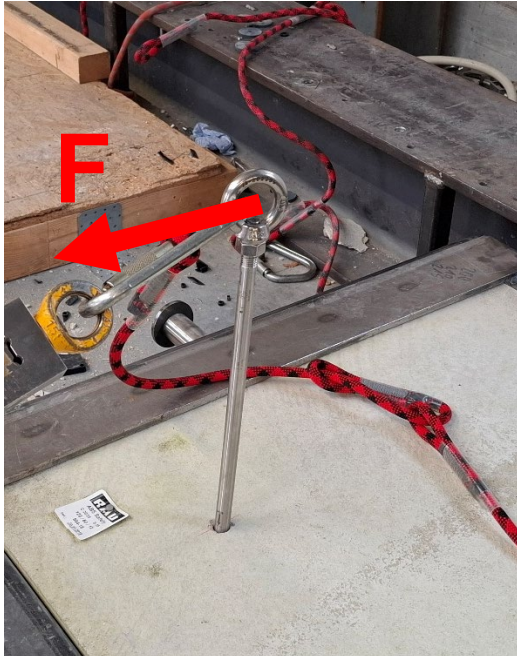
Prüfaufbau G, Anschlagereinrichtung,
